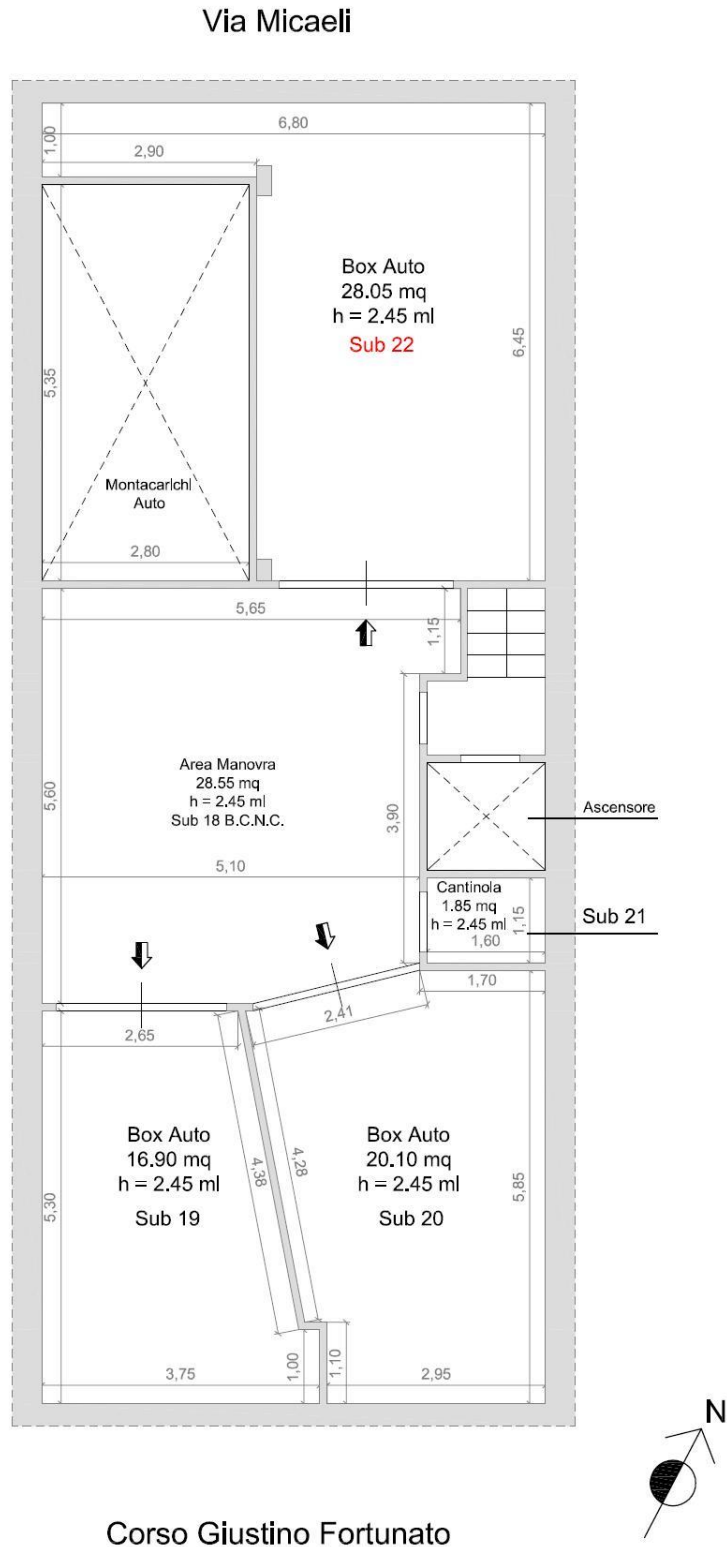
Planimetria Stato di Fatto Garage Piano S2
